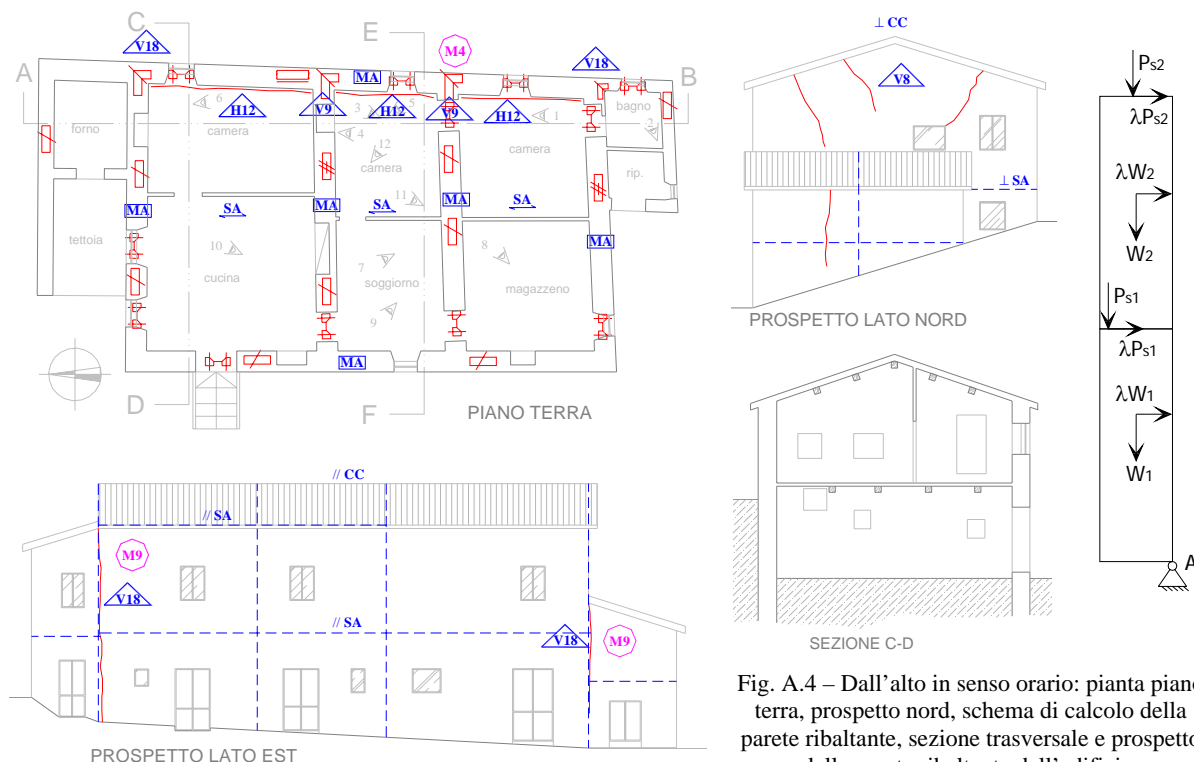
Dall'alto in senso orario: pianta piano terra, prospetto nord, schema di calcolo della parete ribaltante, sezione trasversale e prospetto della parete ribaltante dell'edificio.
